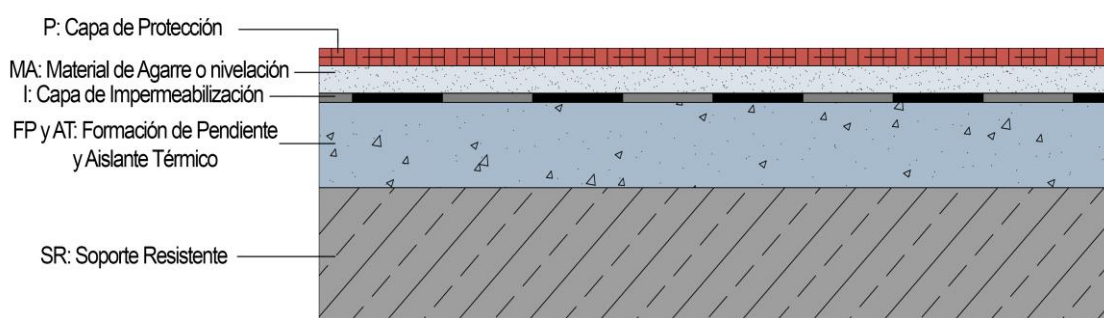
Representación de la cubierta plana emergente en los años 60.
